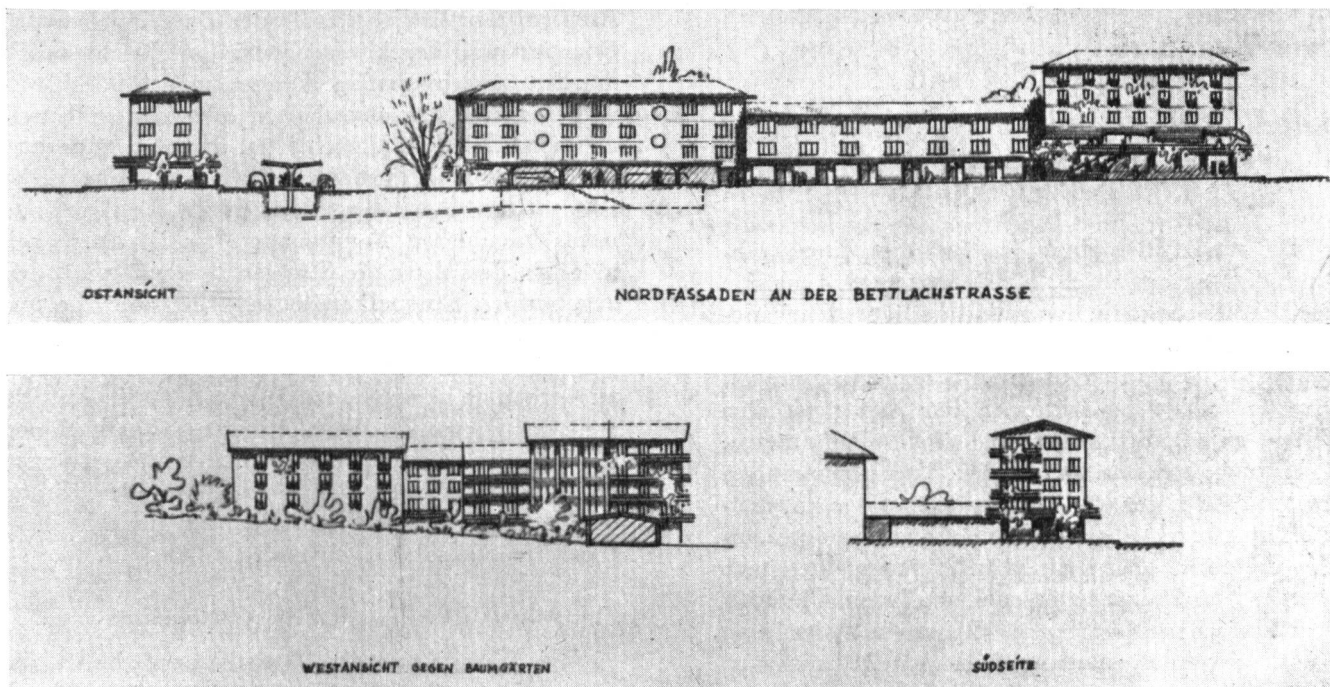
Fassadenskizzen zur Darlegung der Höhenbemessung (Bebauung Bettlachstrasse und Hangseite).
